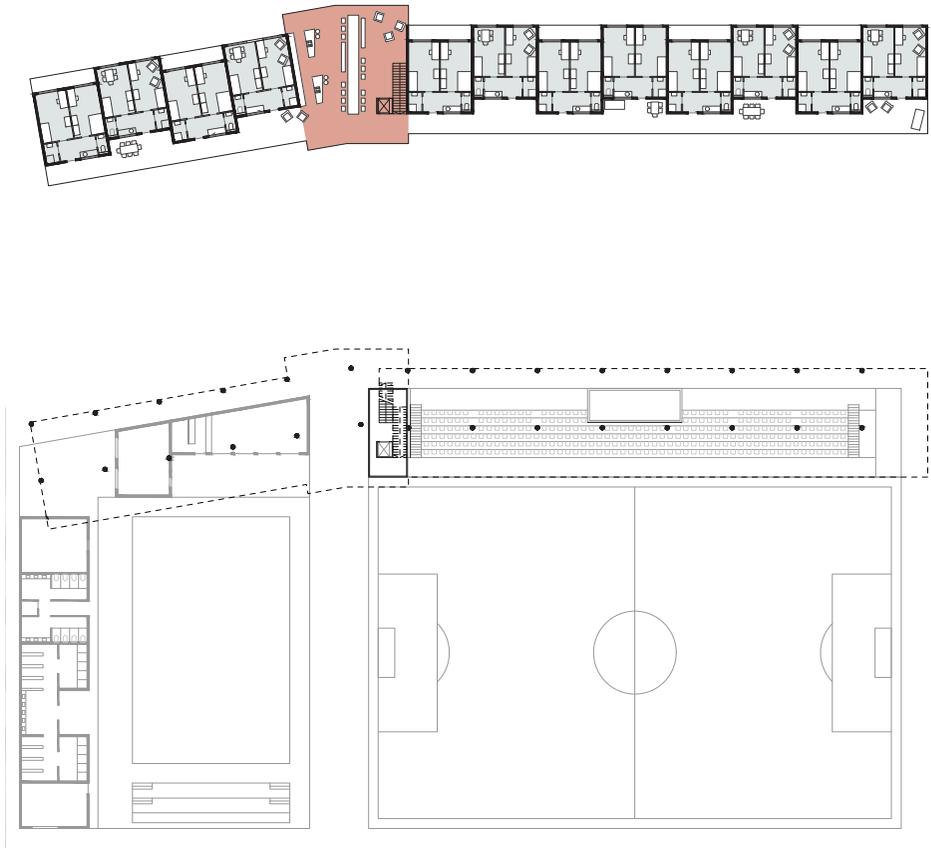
Studentenwohnheim und Fußballplatz, Grundrisse M 1:700 [PS, 2020]
